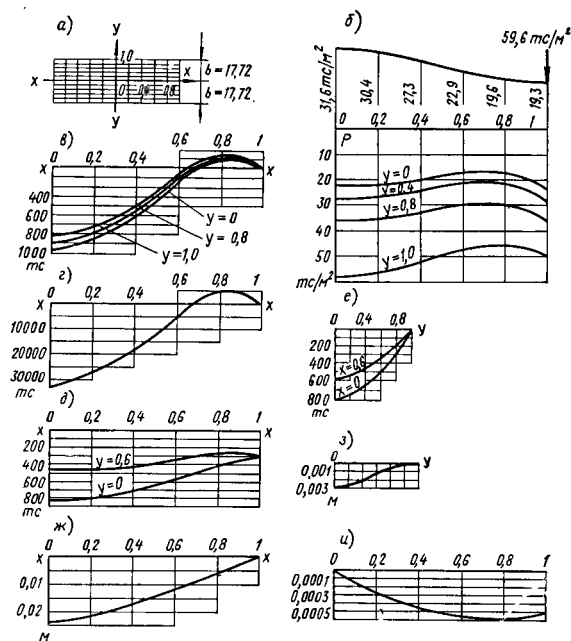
План, нагрузки и расчетные эпюры для коробчатого фундамента высотного здания
